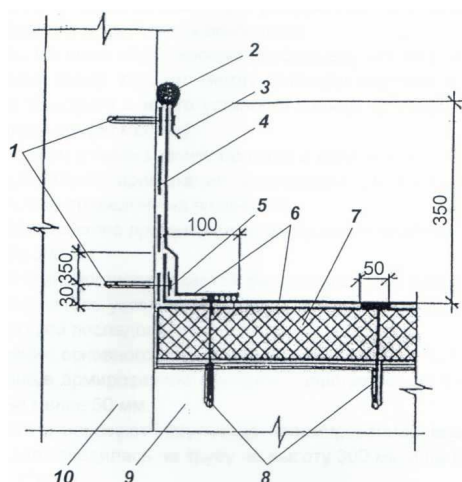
Схема устройства примыкания гидроизоляционного ковра из полимерных мембран к парапету или к стене
